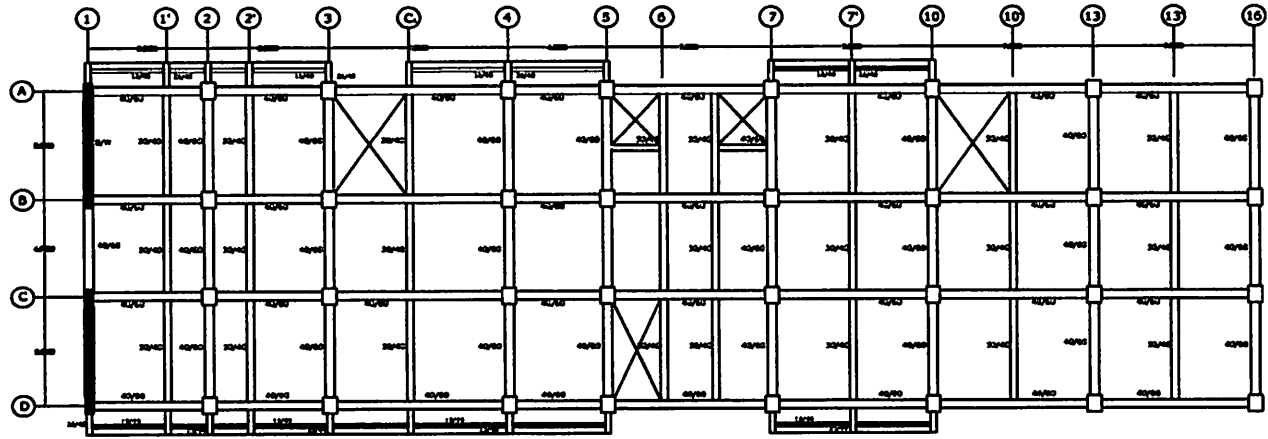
Denah Pembalok Lantai 3 - 8
